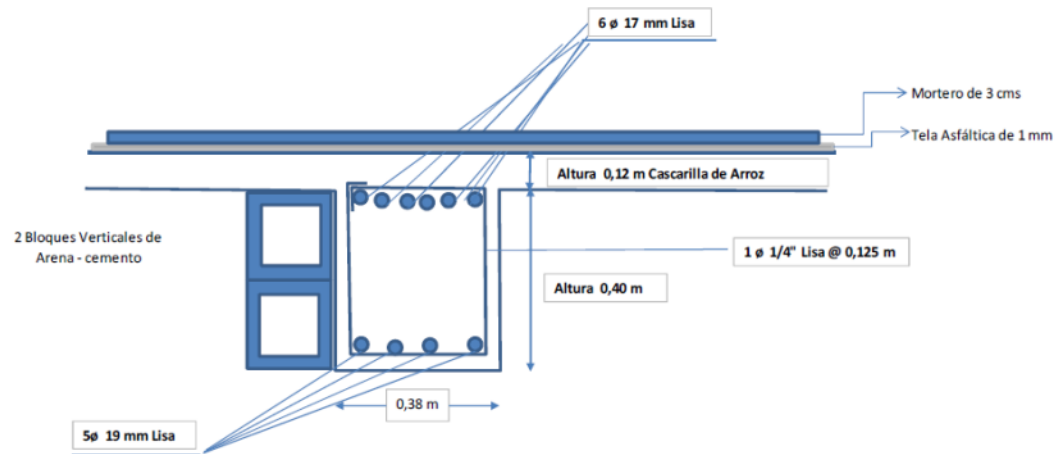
Viga 7 entre Ejes B-C Tercer Piso Segunda Placa
